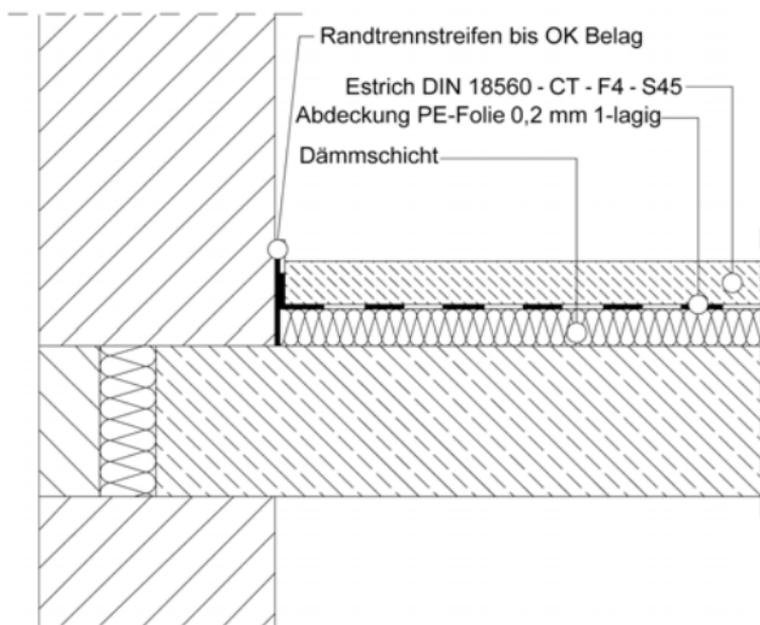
Estrich auf Dämmschicht auf Geschossdecken (Quelle: Hall-schmid)
